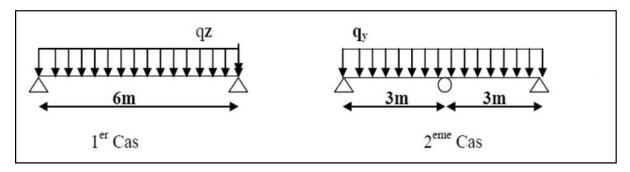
les schémas statiques de la lisse dans les deux plans y-y et z-z.
